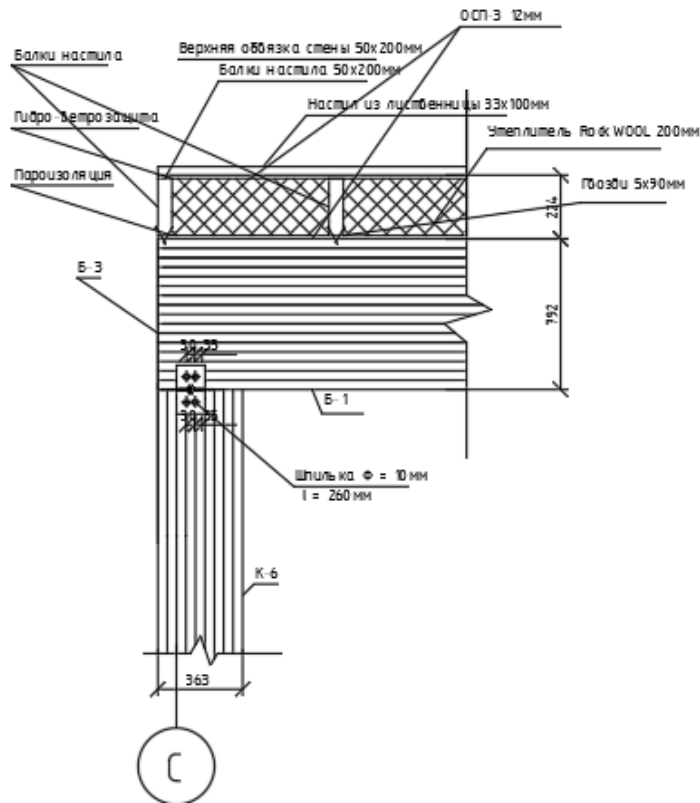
Узел опирания клеенощитой балки на колонну
